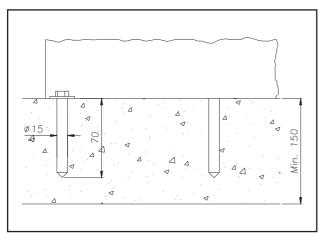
Foratura del pavimento Fig.27 Perçage du plancher
